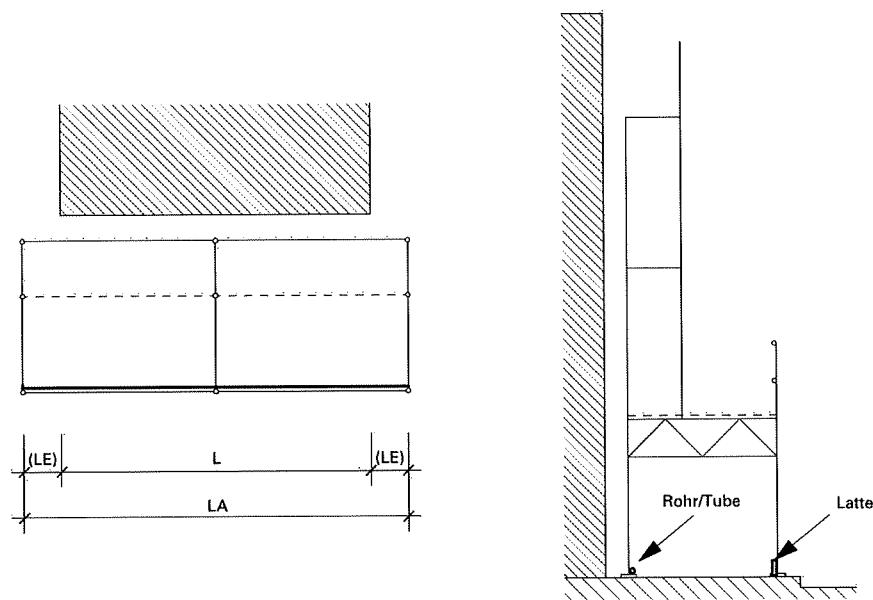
Abschlüsse zwischen Gerüstgang und Fassade
